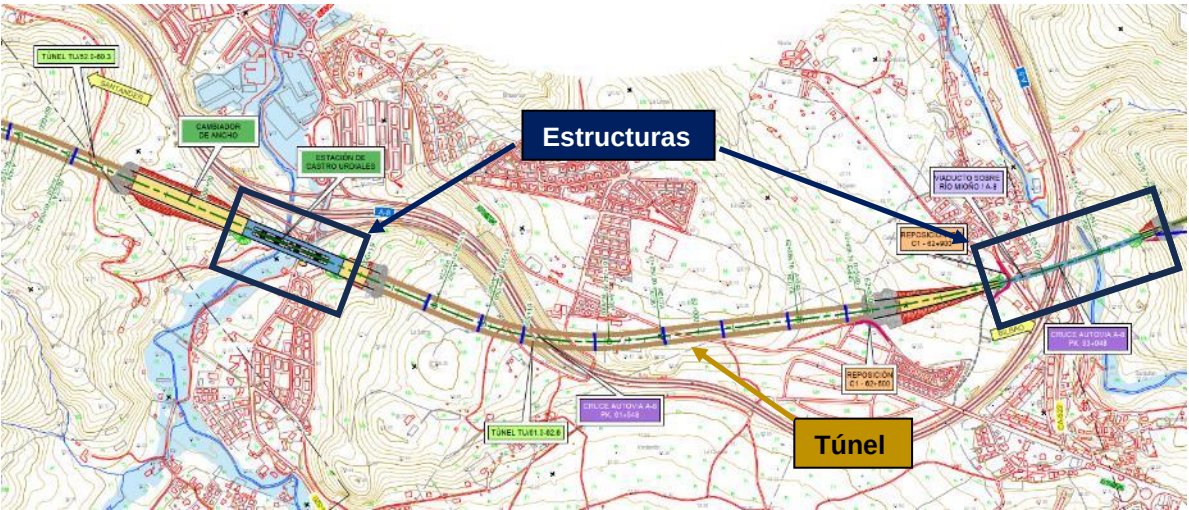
Trazado de la alternativa Rasante Baja. Detalle de estructuras y túnel
